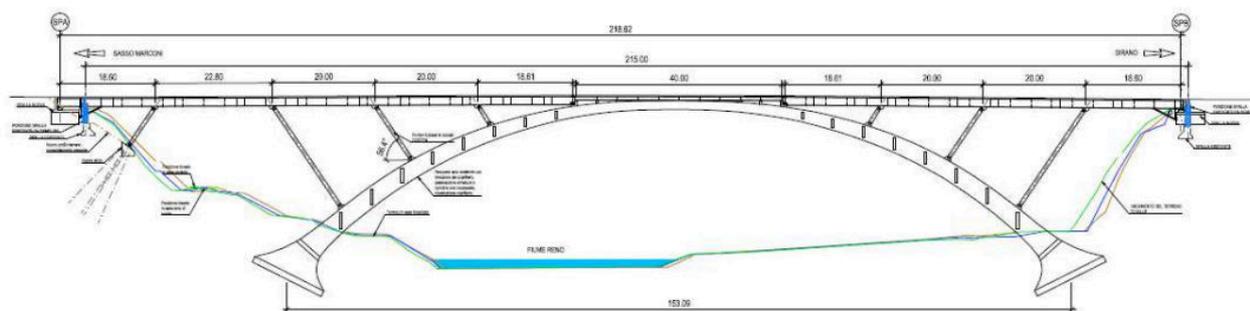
Prospetto longitudinale intervento di progetto (Fonte: Lista di controllo)
